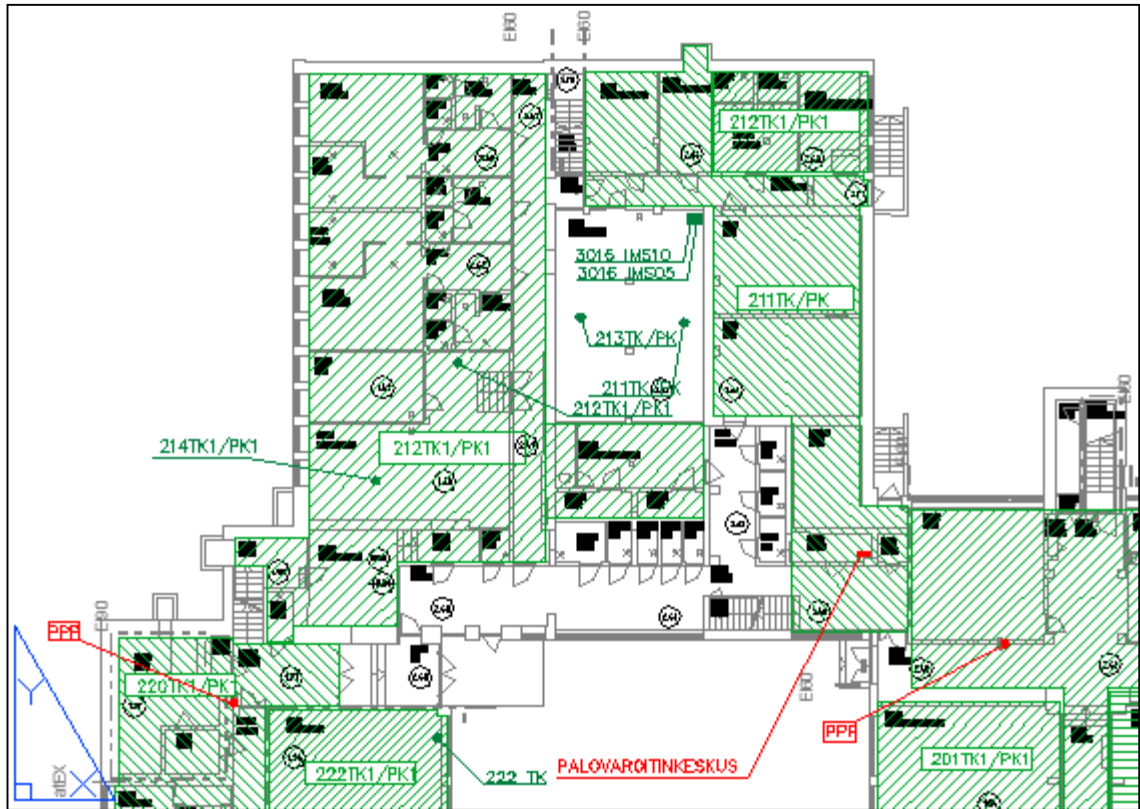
on esimerkkipiirustus LVI- ja sähkösuunnittelijan laitteiden paikantamismerkinnöistä. Kuvassa on esitetty ilmastointi-, vesi- ja viemäri-, lämpö-, ja sähkölaitteet.
